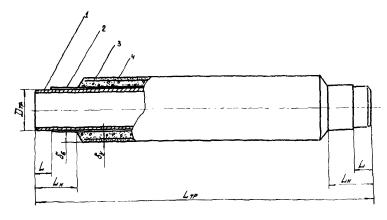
Схема обетонированной трубы: І-труба; 2-изоляционное покрытие; 3-арматурная сетка; 4-бетонное покрытие
